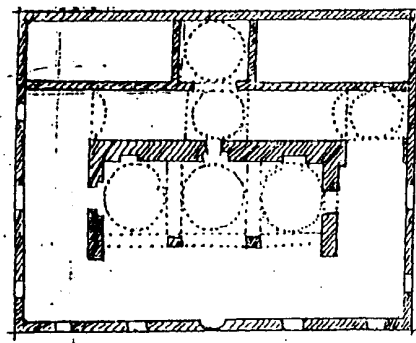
مسقط أفقى لمدرسة الإسكندرية
